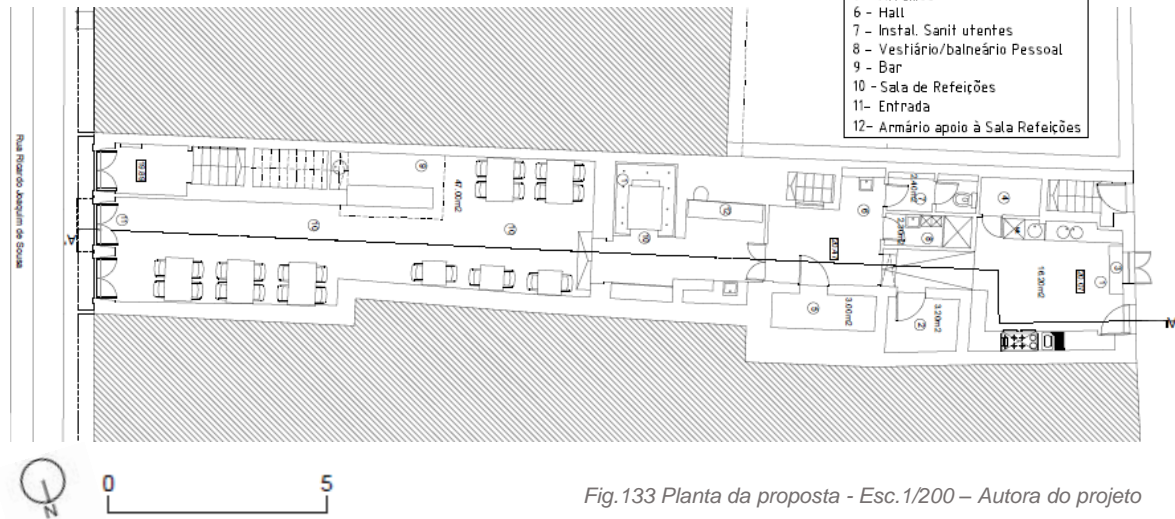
Planta da proposta - Esc.1/200 – Autora do projeto
